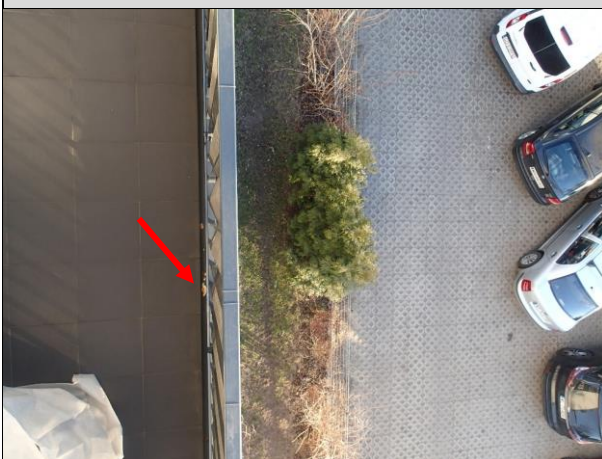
Obróbki krawędziowe ze zdecydowanym spadkiem w kierunku „od budynku” – prawidłowo.
